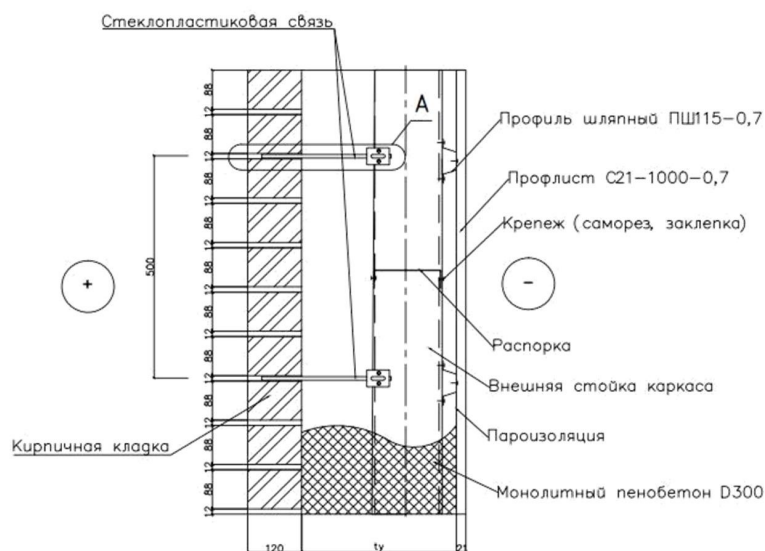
Фасадная система из пенобетона и металлического профилированного листа смонтированная на кирпичной кладке
